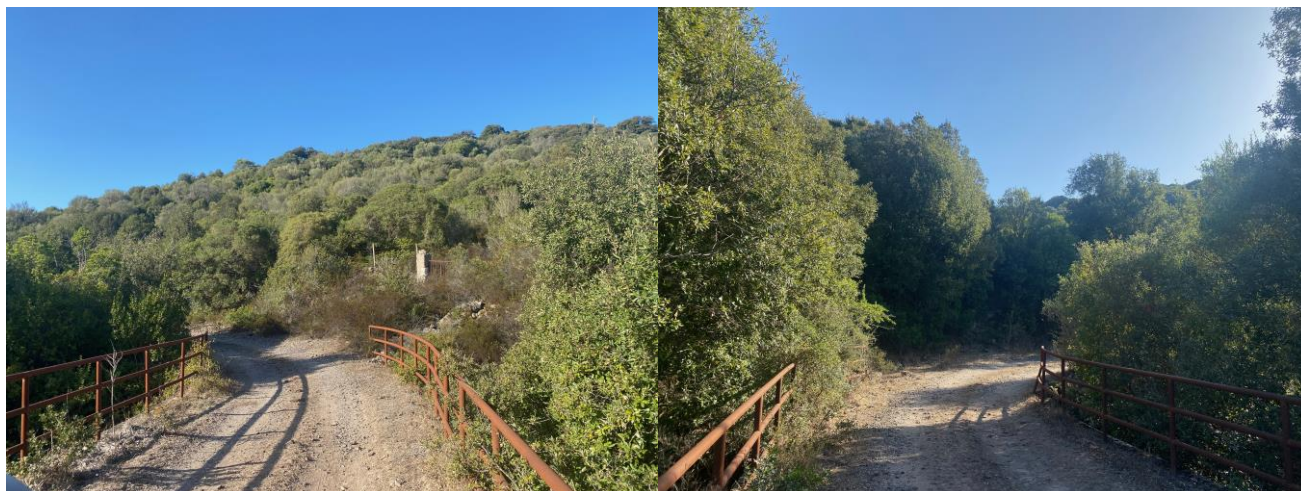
Strada di accesso alla traversa Sette Ortas
